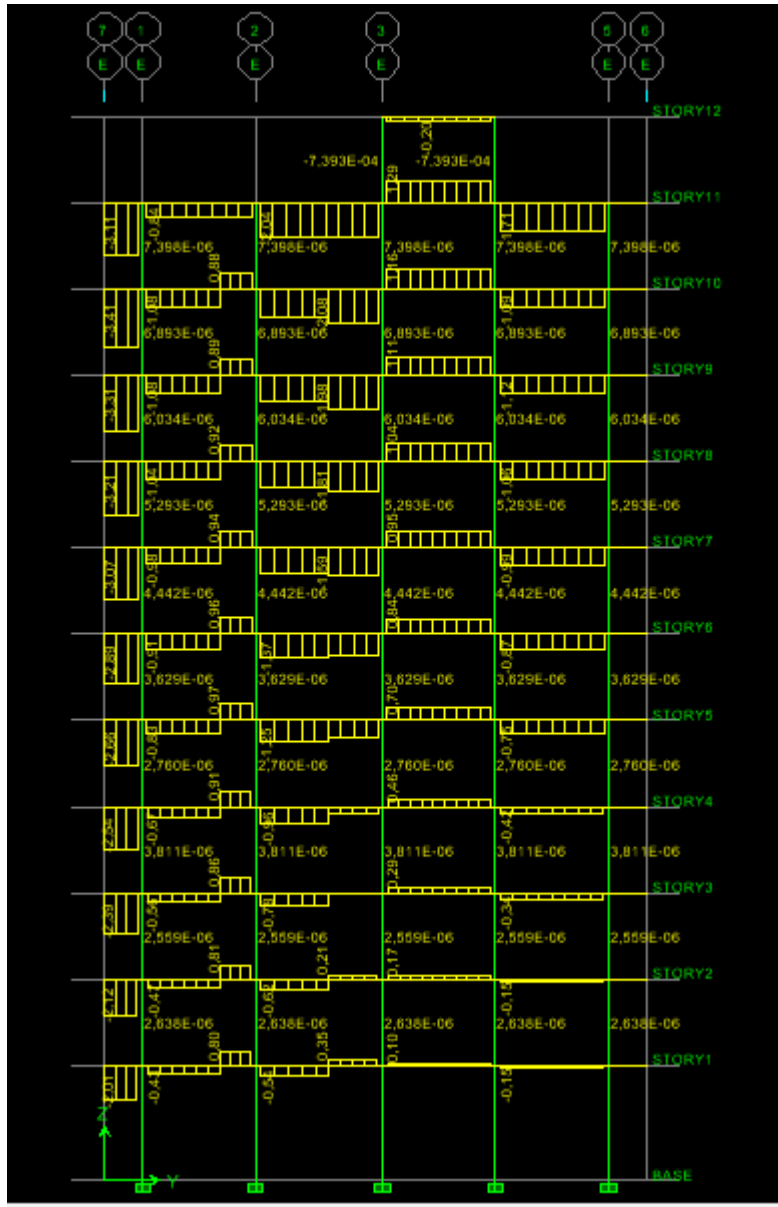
Exemple de la torsion aux des poutres, axe2.
